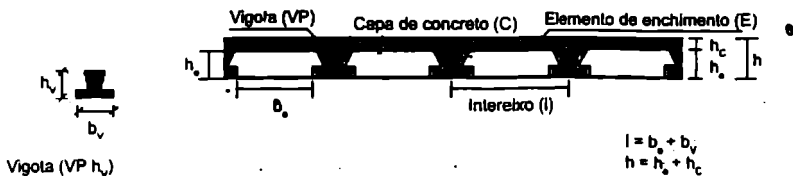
Laje pré-fabricada com vigotas de concreto protendido (LP).
